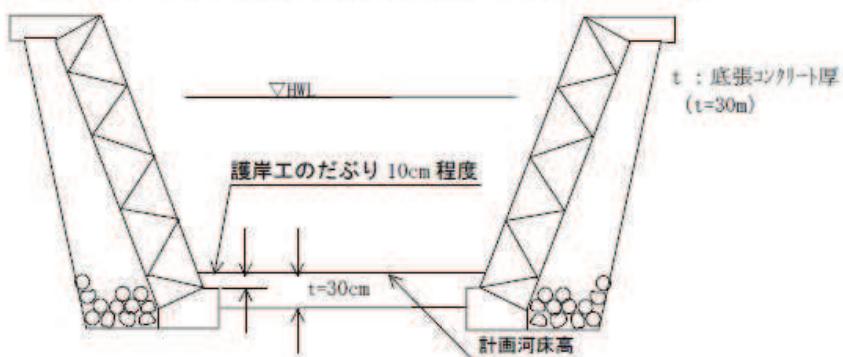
コンクリート張りの構造及び護岸の根入れ
